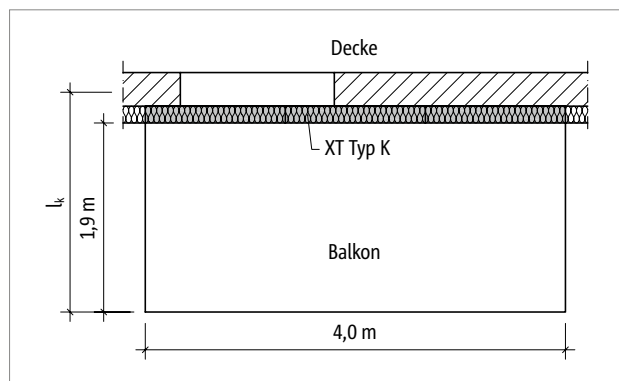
Schöck Isokorb® XT Typ K: Grundriss
